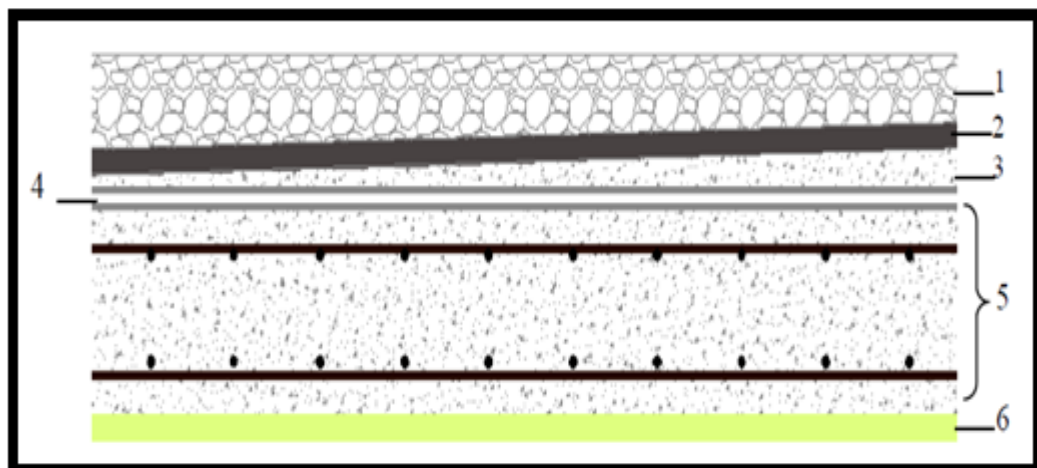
Composants d'un plancher terrasse en dalle pleine.
